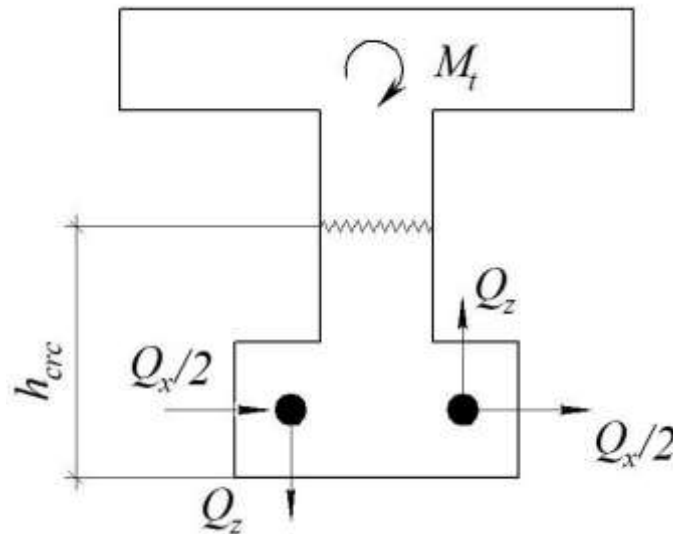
Схема нагельних сил в поздовжній арматурі елемента двотаврового перерізу
